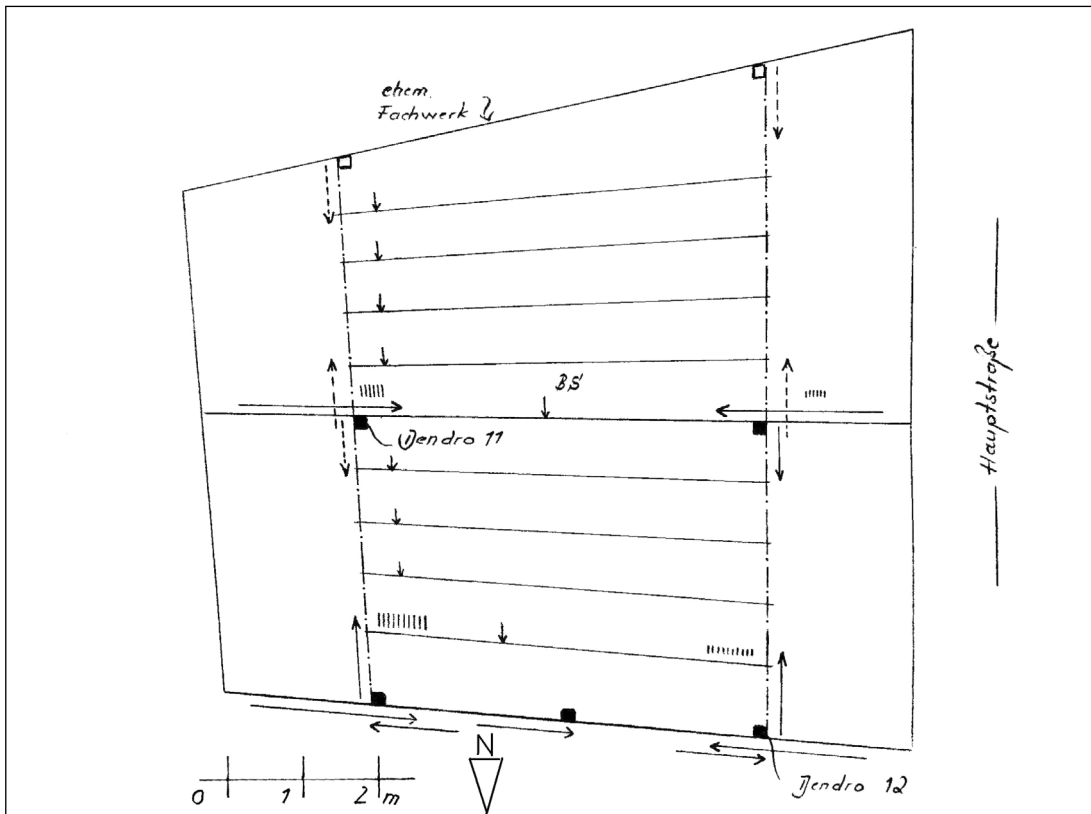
Hauptstraße 15, Grundriss 1. Dachgeschoss.
